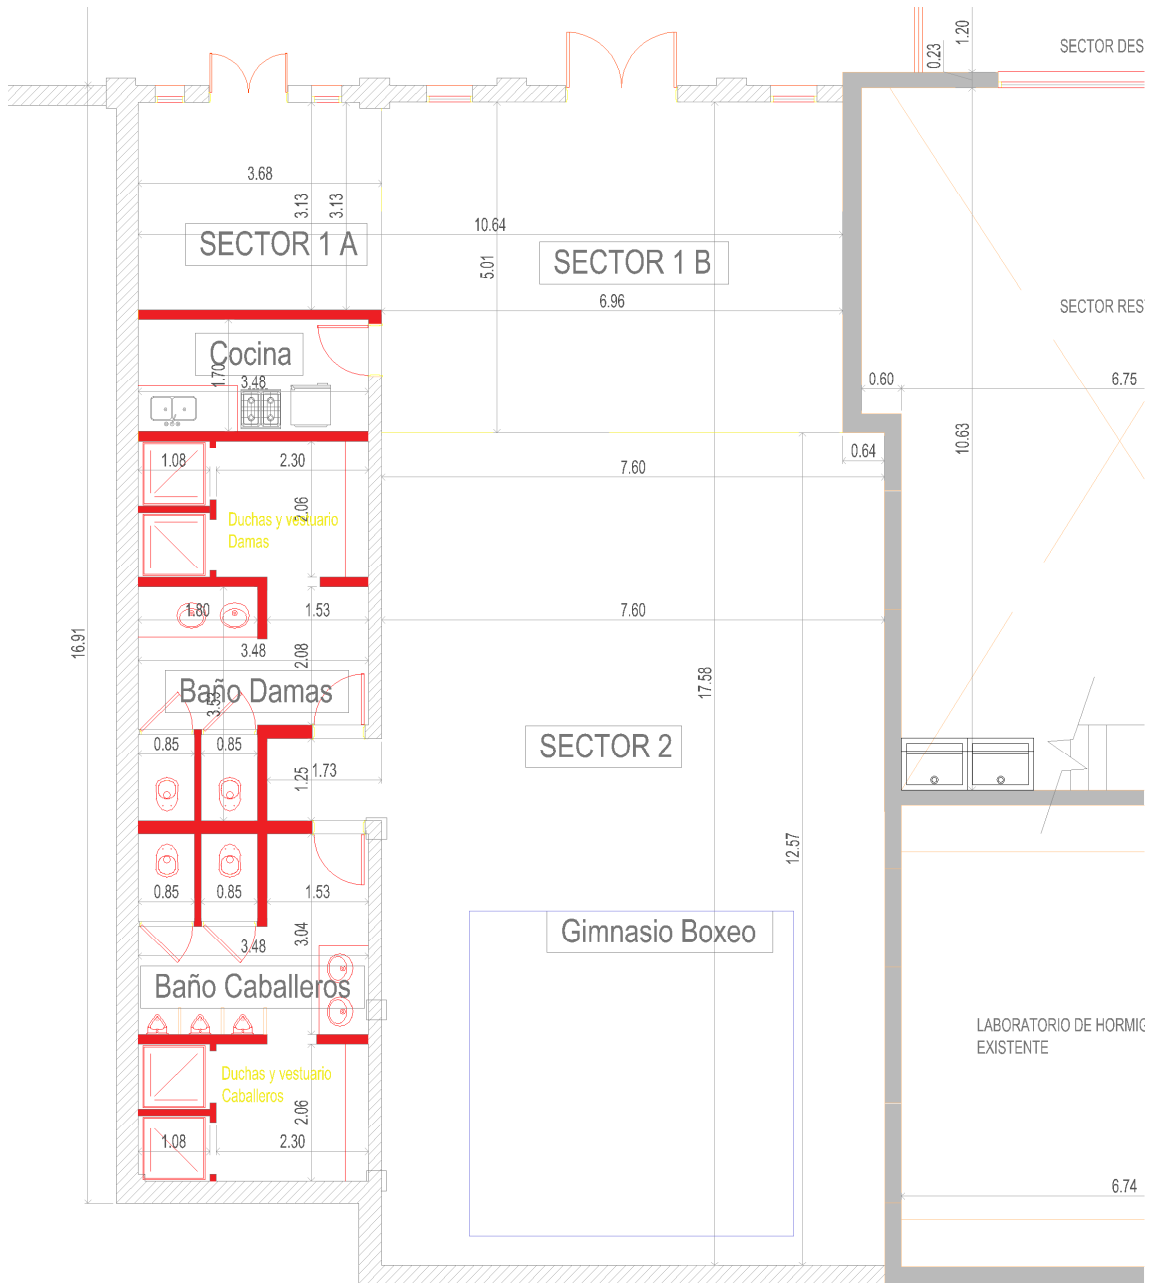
PLANTA REFUNCIONALIZADA GIMNASIO MUNICIPAL DE BOX
